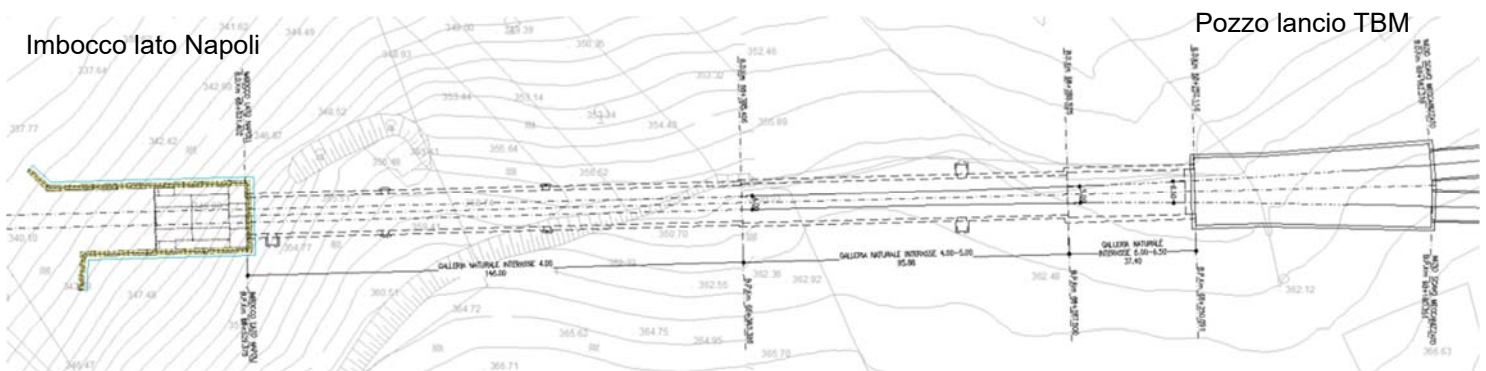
Planimetria imbocco GN Tradizionale imbocco lato Napoli
